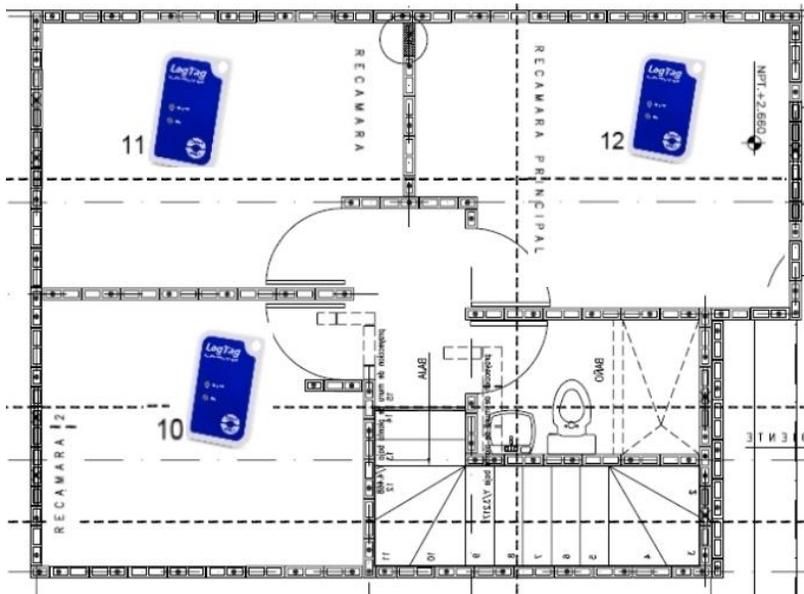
Planta arquitectónica de la vivienda dos, segundo nivel. Orientada al Oeste
